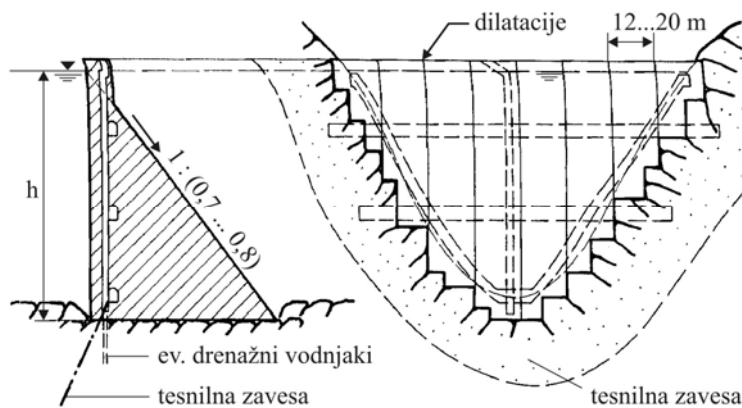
Betoniranje lamel po izmeničnem, stopničastem načinu
